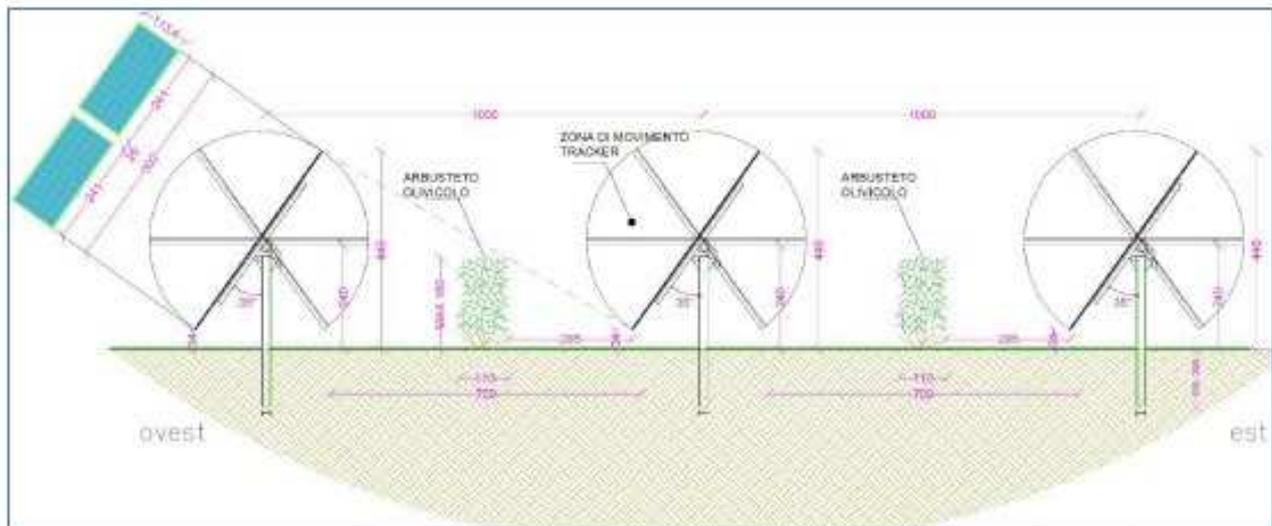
Sezione tipo impianto con installazione su sistema ad inseguimento solare tipo tracker
